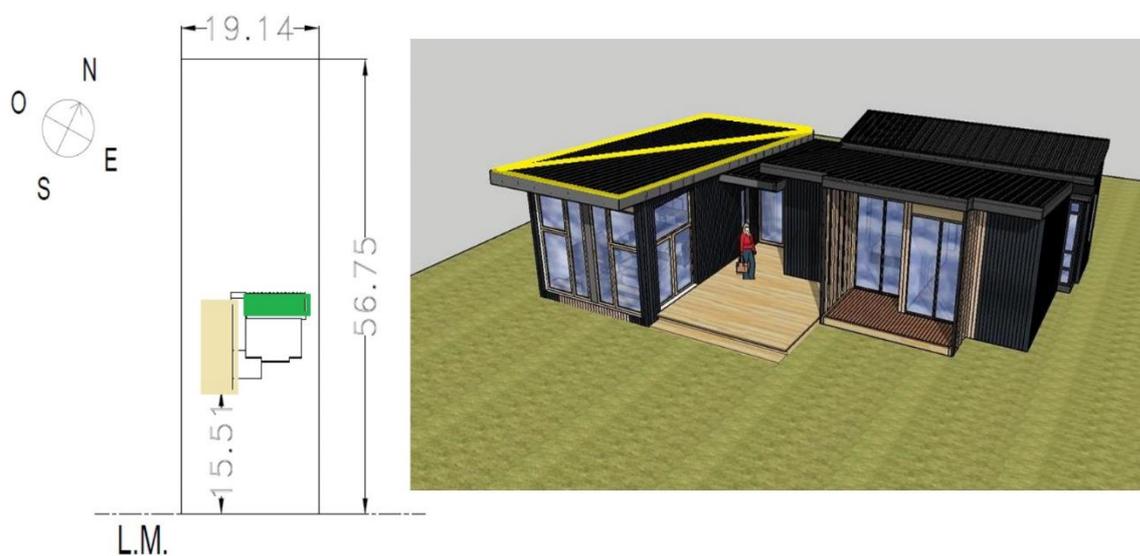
Proyecto Playa - Vivienda Tipo-Distribución Techos
